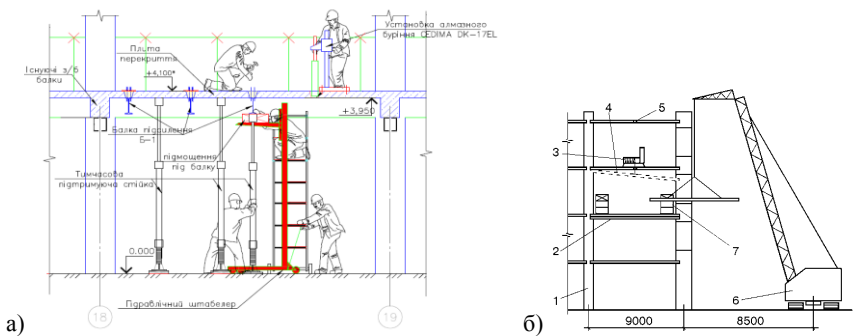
Схеми влаштування конструкцій балок підсилення перекриття: а- плановий варіант; б- фактично прийнята схема робіт; 1- наявна будівля; 2- встановлена балка; 3- ручна лебідка; 4- балка підсилення, що підводиться; 5- отвір для пропуску тросу лебідки; 6- кран; 7- риштування
